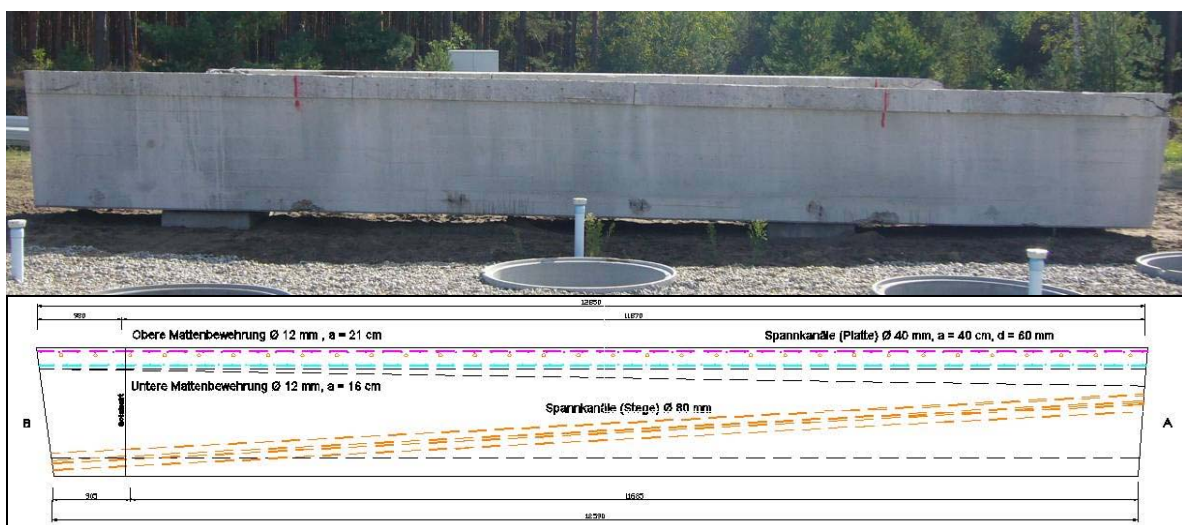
Längsansicht und Darstellung Bewehrungslagen eines Brückenlängsträgers
